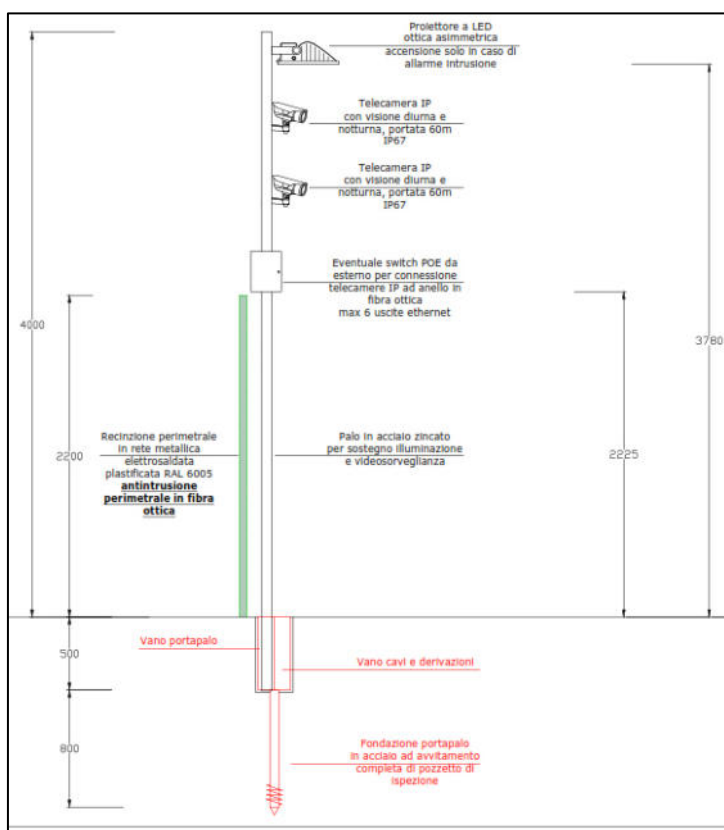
Particolare dei pali previsti per illuminazione e videosorveglianza con fondazione a vite.
